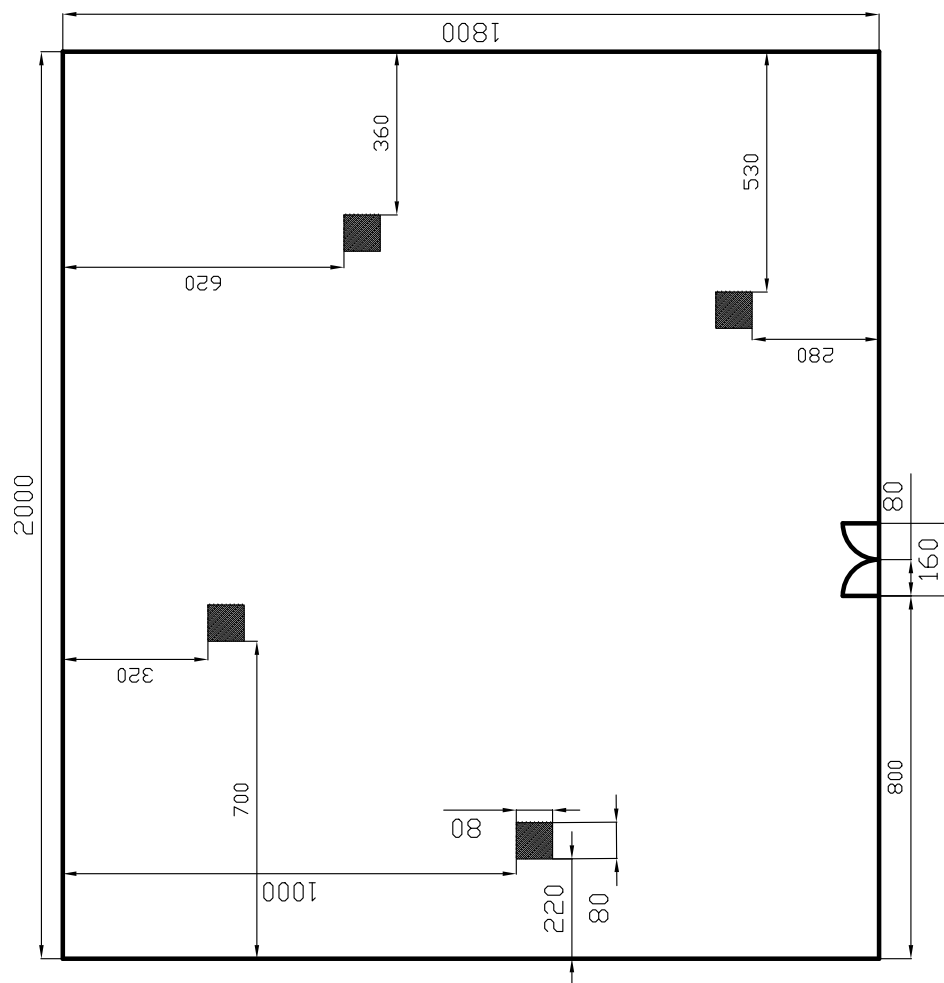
Půdorys sálu pro Lokalitu 2.
